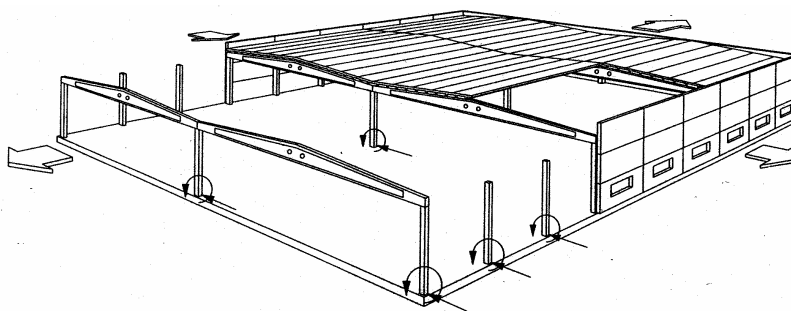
Estrutura apórticada estabilizada pela ação em balanço dos pilares
